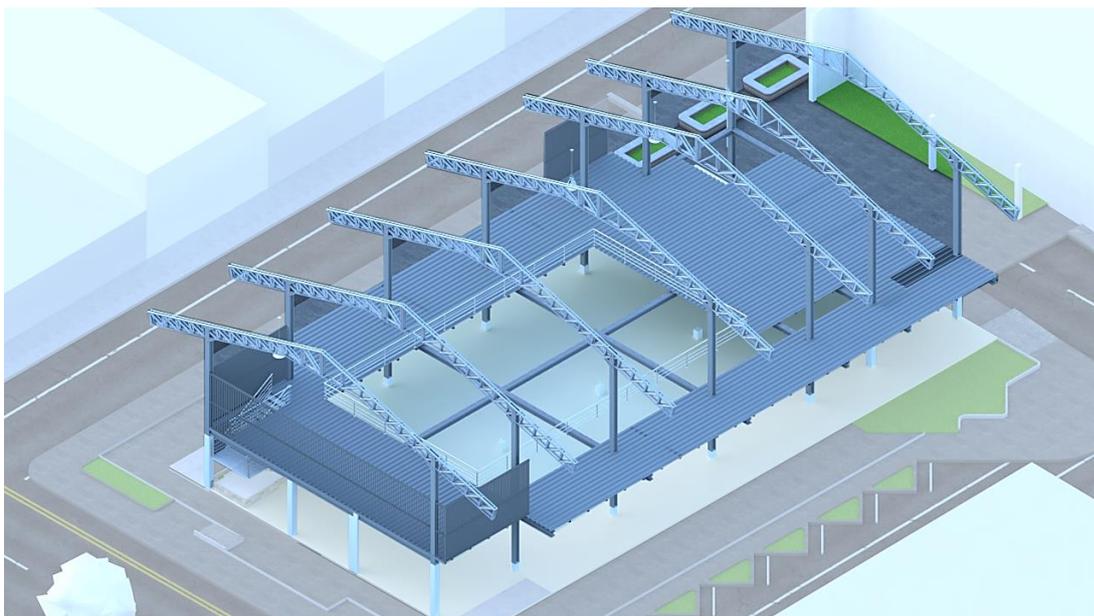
Propuesta de estructura, Elaborado por: Ayala, A. 2022
